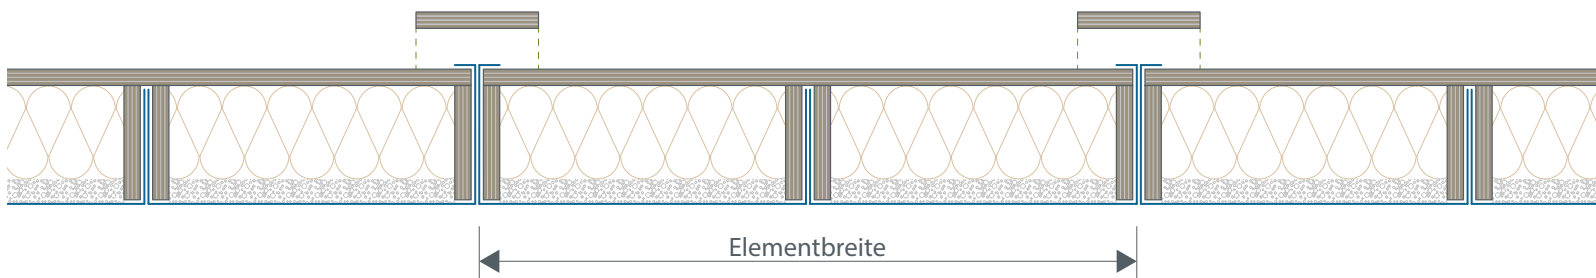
Entwurfsansatz 01-2 - LVL- Rippendecke mit Stahlblech Tragschale (Vertikalschnitt)
